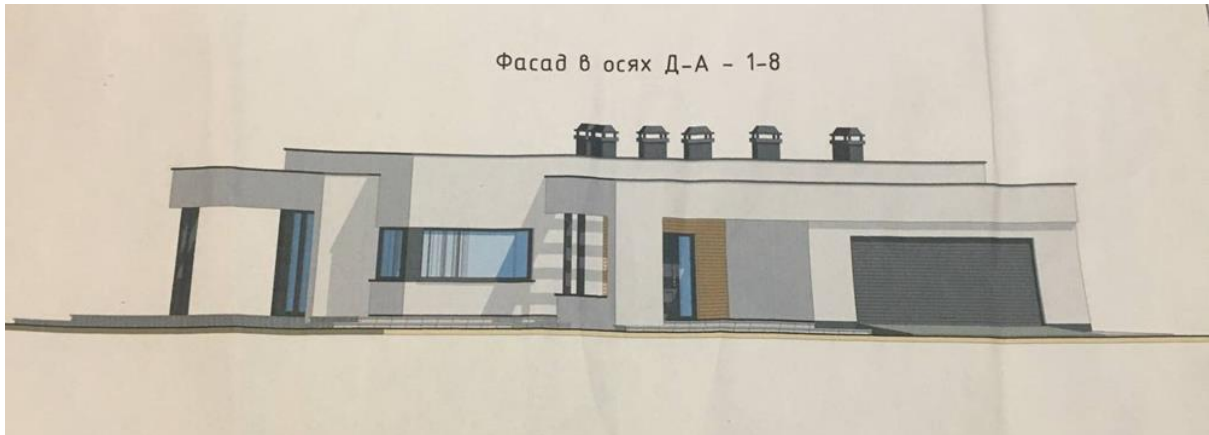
Зображення фасаду досліджуваного будинку в осях Д-А – 1-8.
